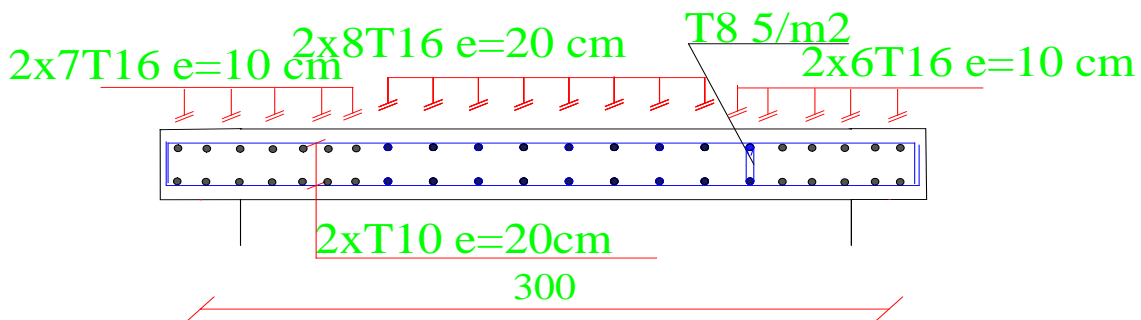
ferrailage coupe des voiles 01 (tous les étages)
